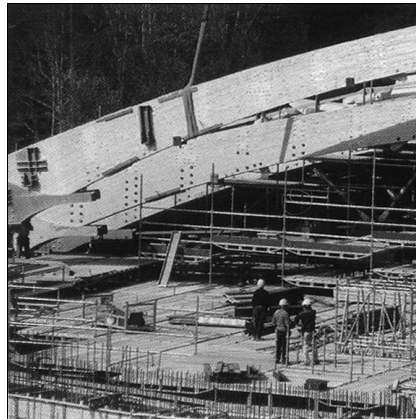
Fase di montaggio delle travi in legno lamellare
